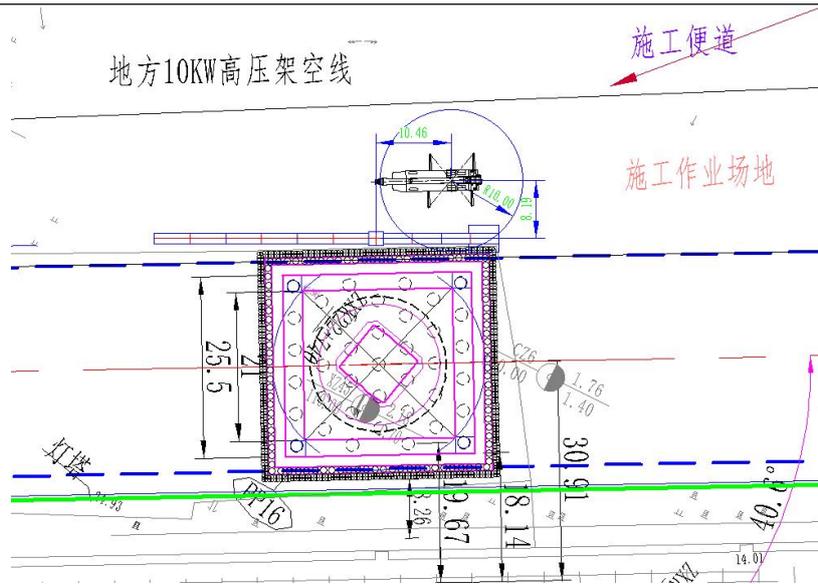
平衡臂臂节二拆除平面图 (单位: m)
